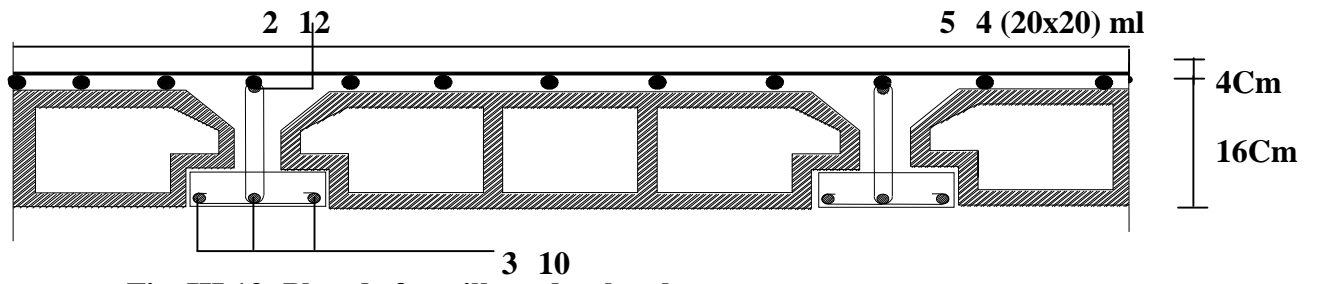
Plan de ferrailage du plancher en corps creux.
